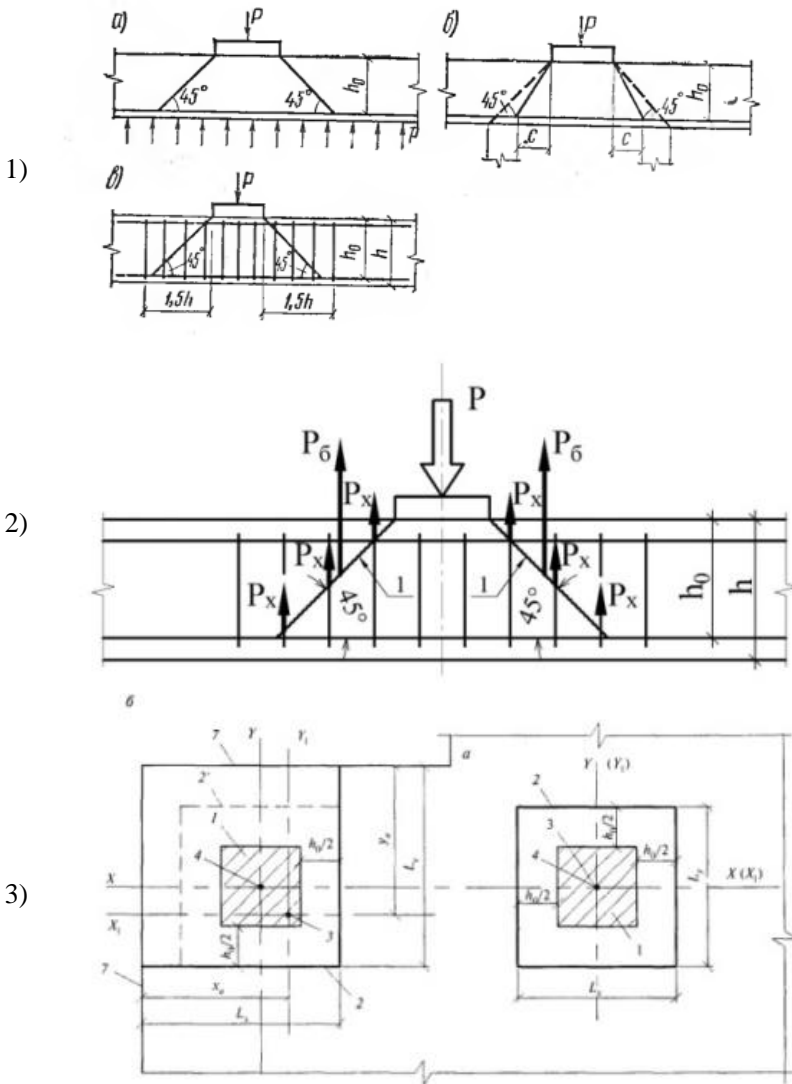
1) - Схема расчета на продавливание: а – расчетная пирамида; б – пирамида при стесненных условиях; в – расположение трещины в пределах хомутов; 2) - Схема расчёта на продавливание плит согласно СНиП 2.03.01–84; 3) - Схема расчёта на продавливание плит согласно СП 52-101-2003: а – площадка приложения нагрузки внутри плоского элемента; б – то же, у края плоского элемента;
